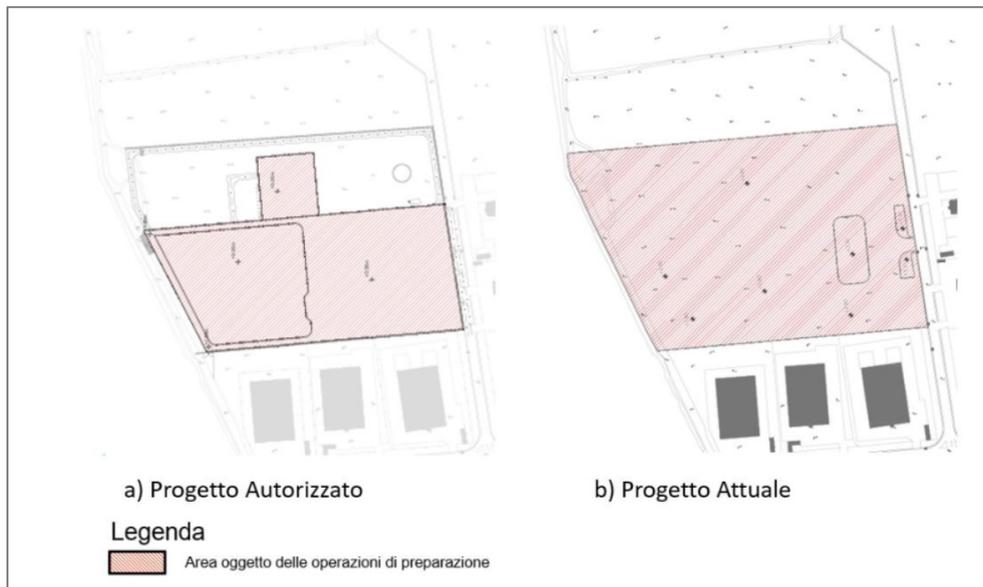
Aree Oggetto delle Operazioni di Preparazione (Progetto Autorizzato e Progetto Attuale)
